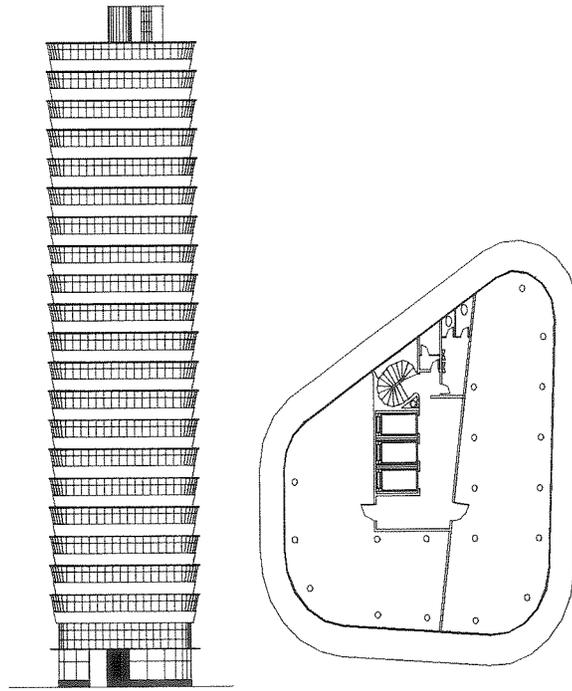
Projeto apresentado à Prefeitura inicialmente. Elevação e planta-tipo.
